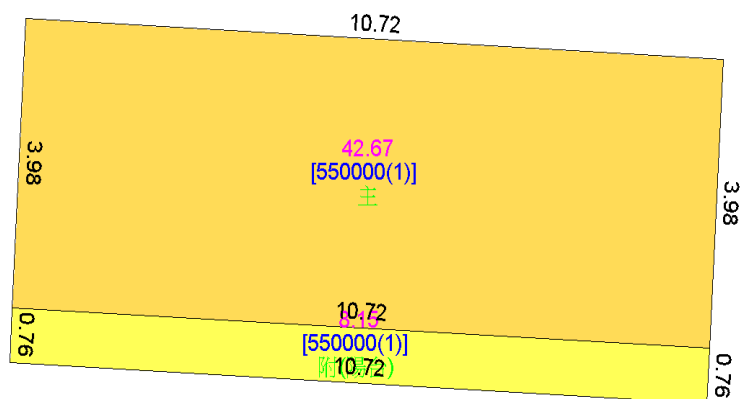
、三維地籍建物之建物平面測量成果圖（透天）
